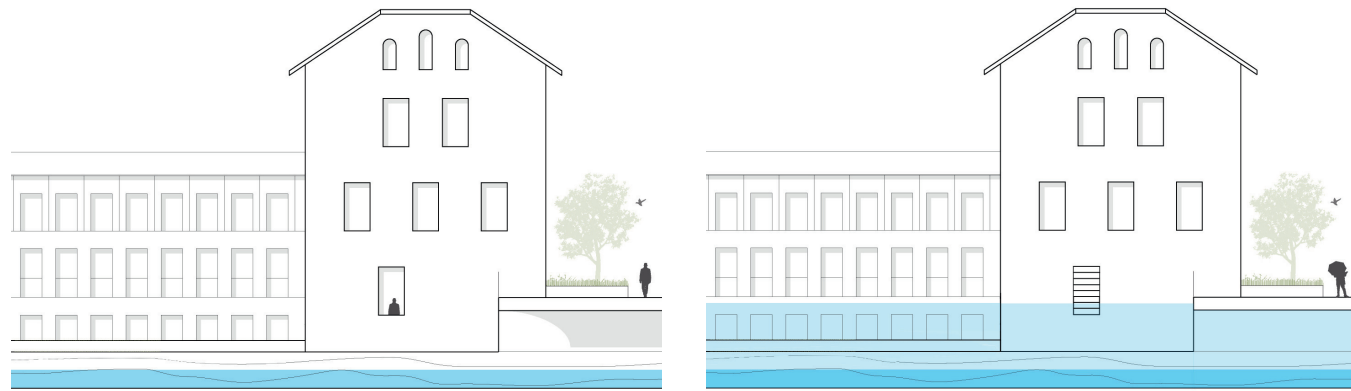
Schnittansicht: Bahnhofsstraße und angrenzende Bebauung bei Niedrigwasser und bei Hochwasser
